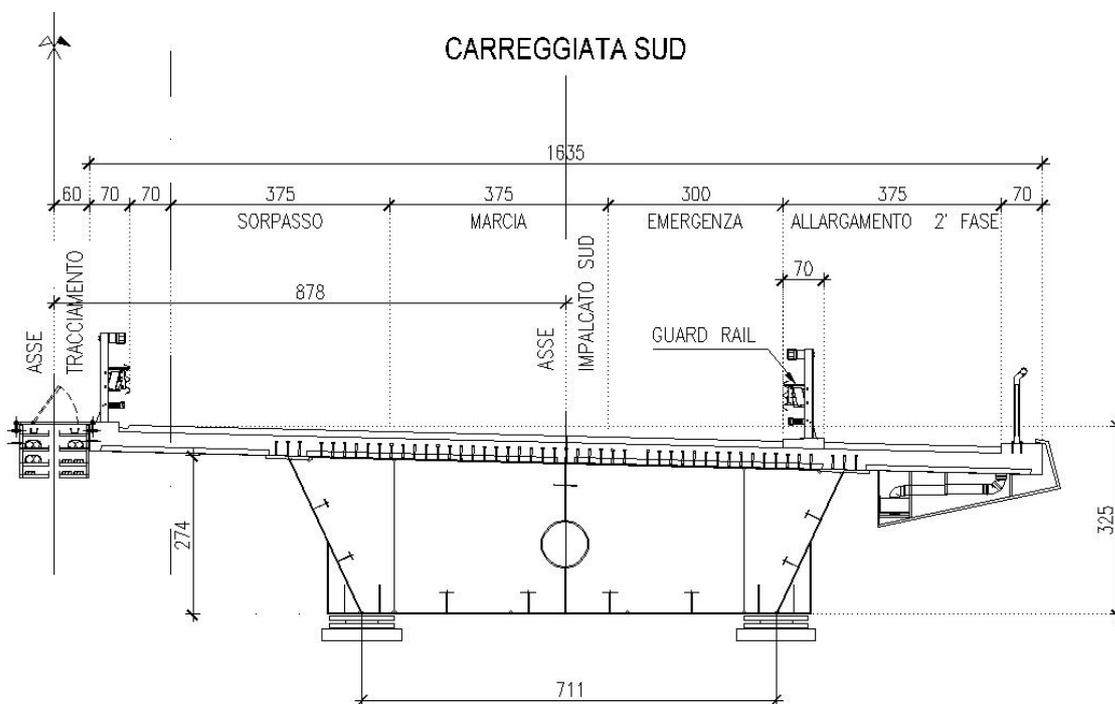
SEZIONE TIPICA IMPALCATO MISTO ACCIAIO-CLS DI PD
